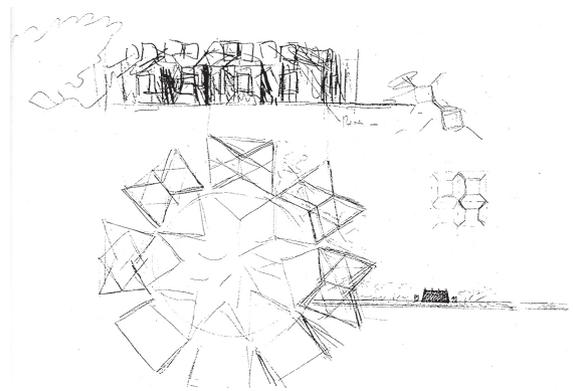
Primeira Igreja Unitária e Escola. Croquis. Planta e elevação (junho-julho, 1959).
